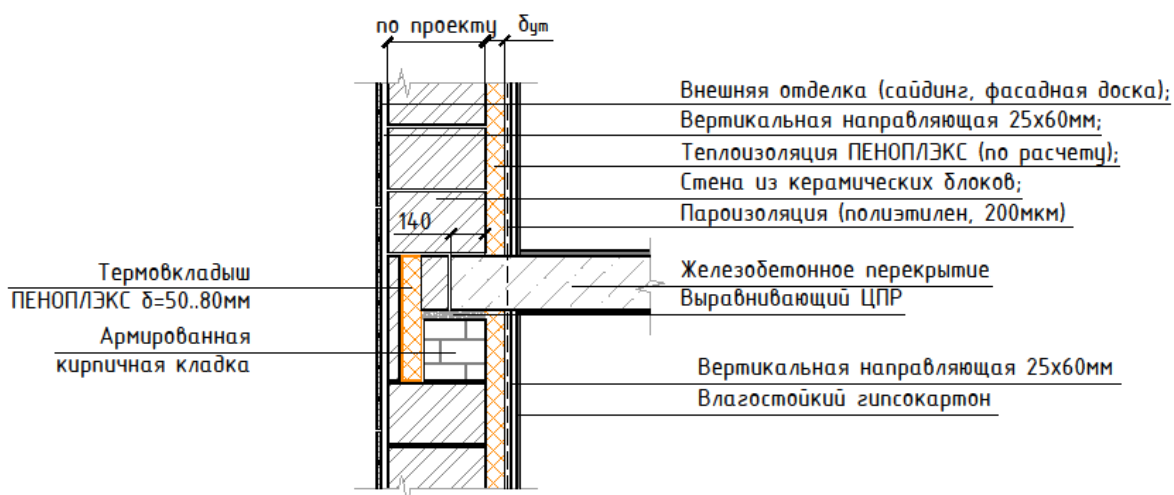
Схема сопряжения стены из керамических блоков с железобетонным перекрытием (плиты ПЕНОПЛЭКС изнутри).
